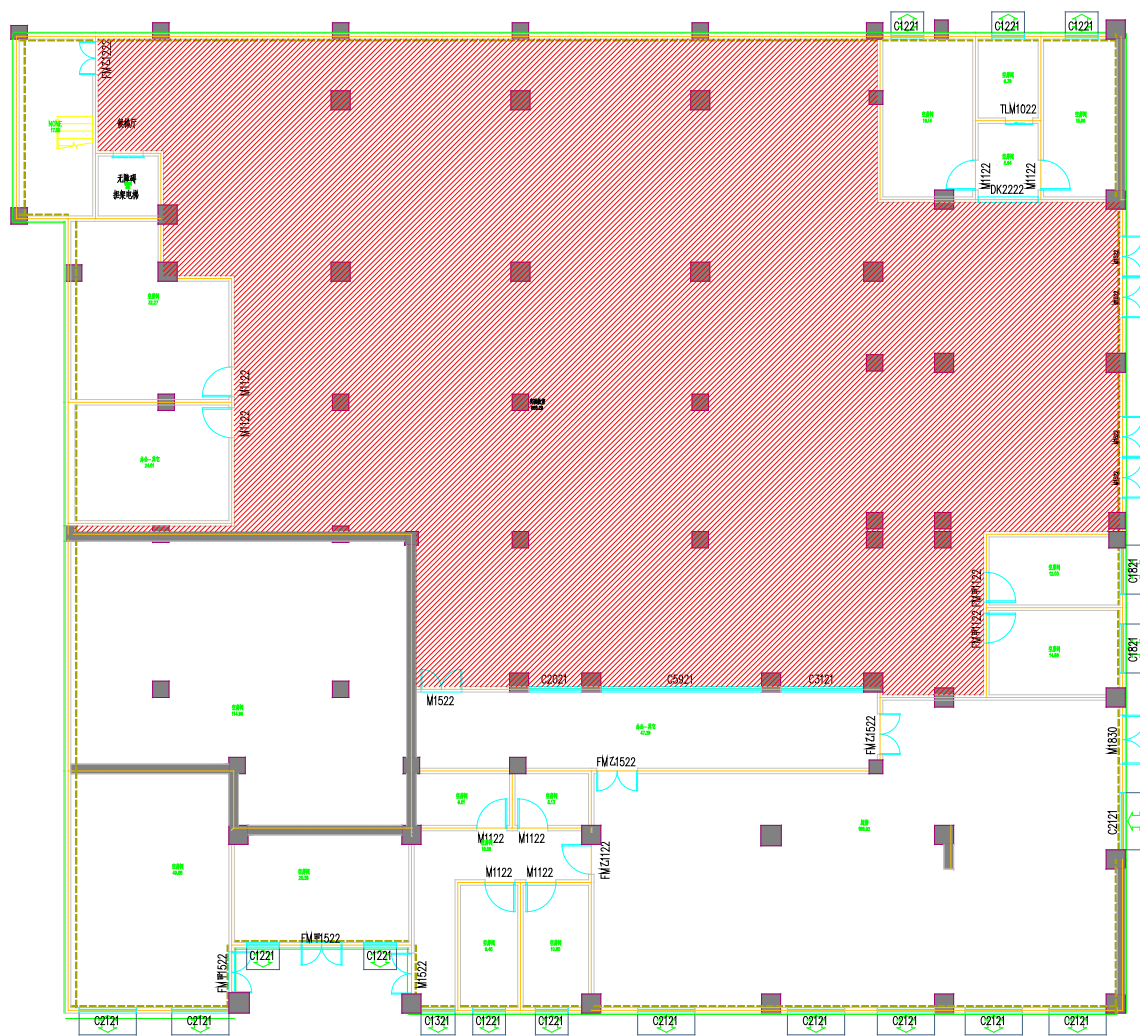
受建筑内设备噪声影响的典型房间楼层平面图
